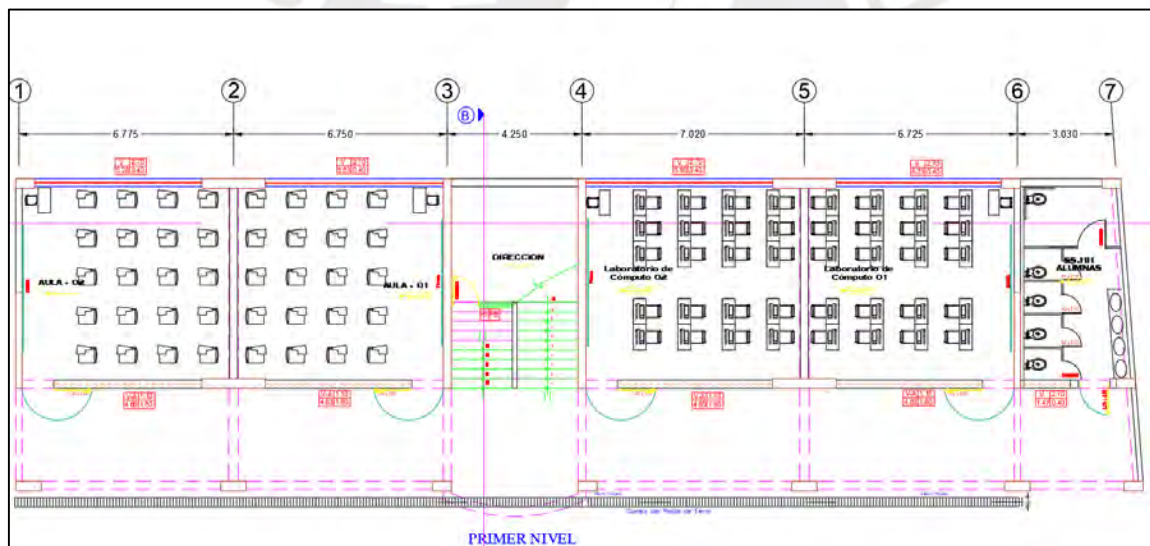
Vista en planta del primer nivel del pabellón del plano de arquitectura. Fuente: Propia
